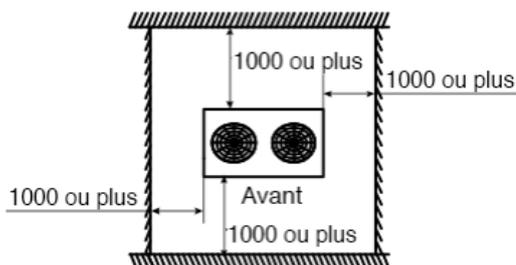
Installation d'une seule rangée (unité : mm)
